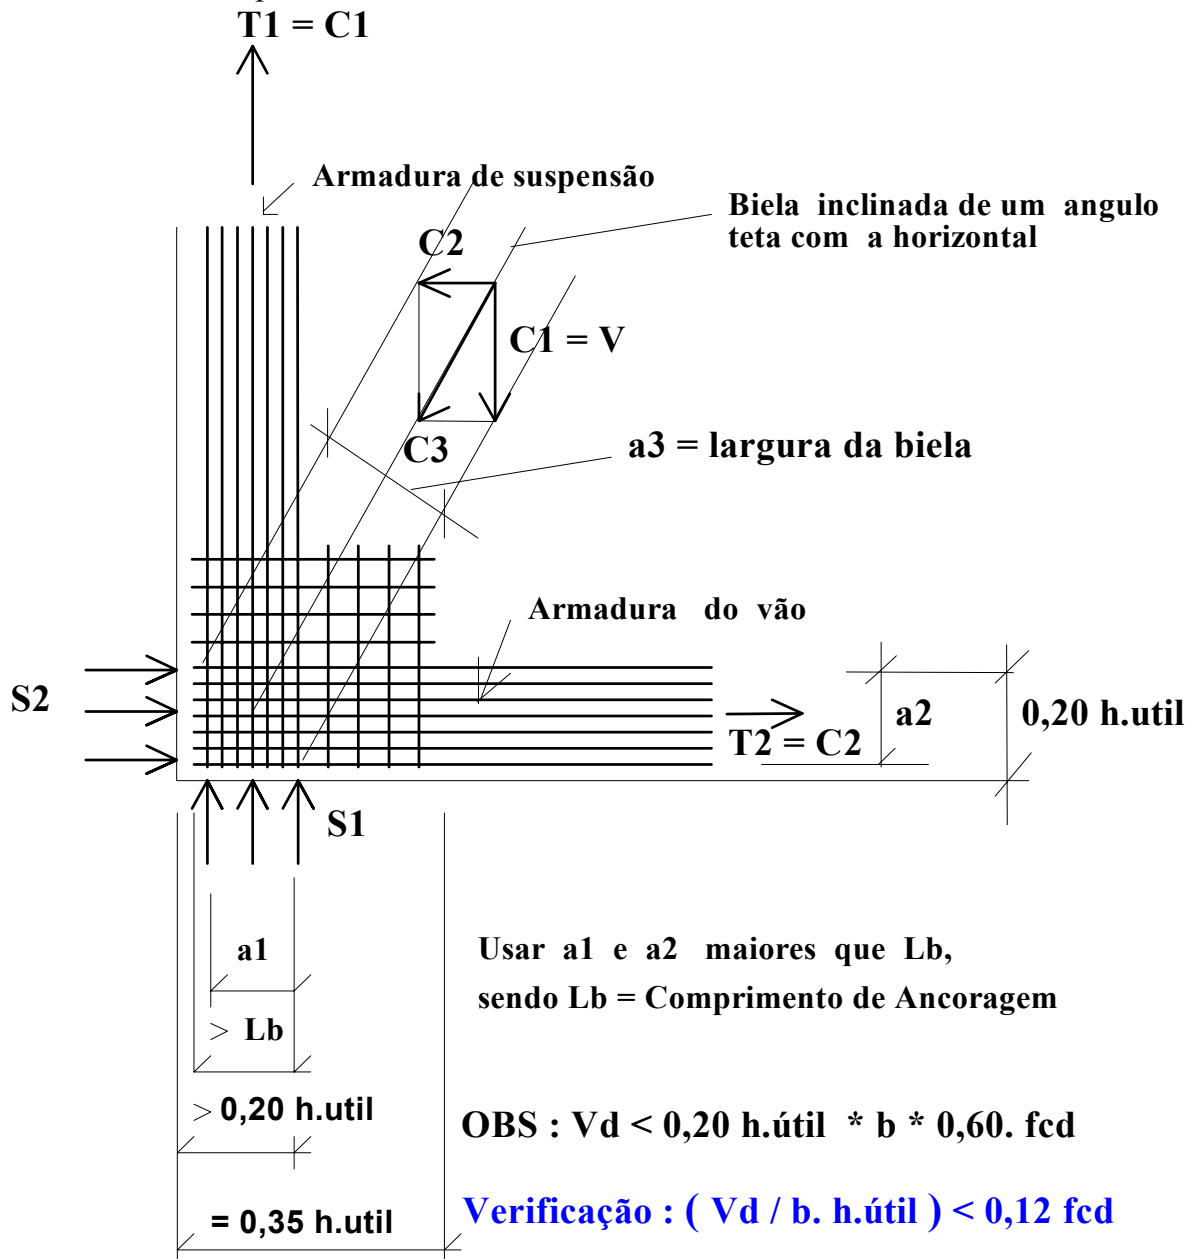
Nó extremo em um Apoio Indireto, isto é, com Armadura de Suspensão.
